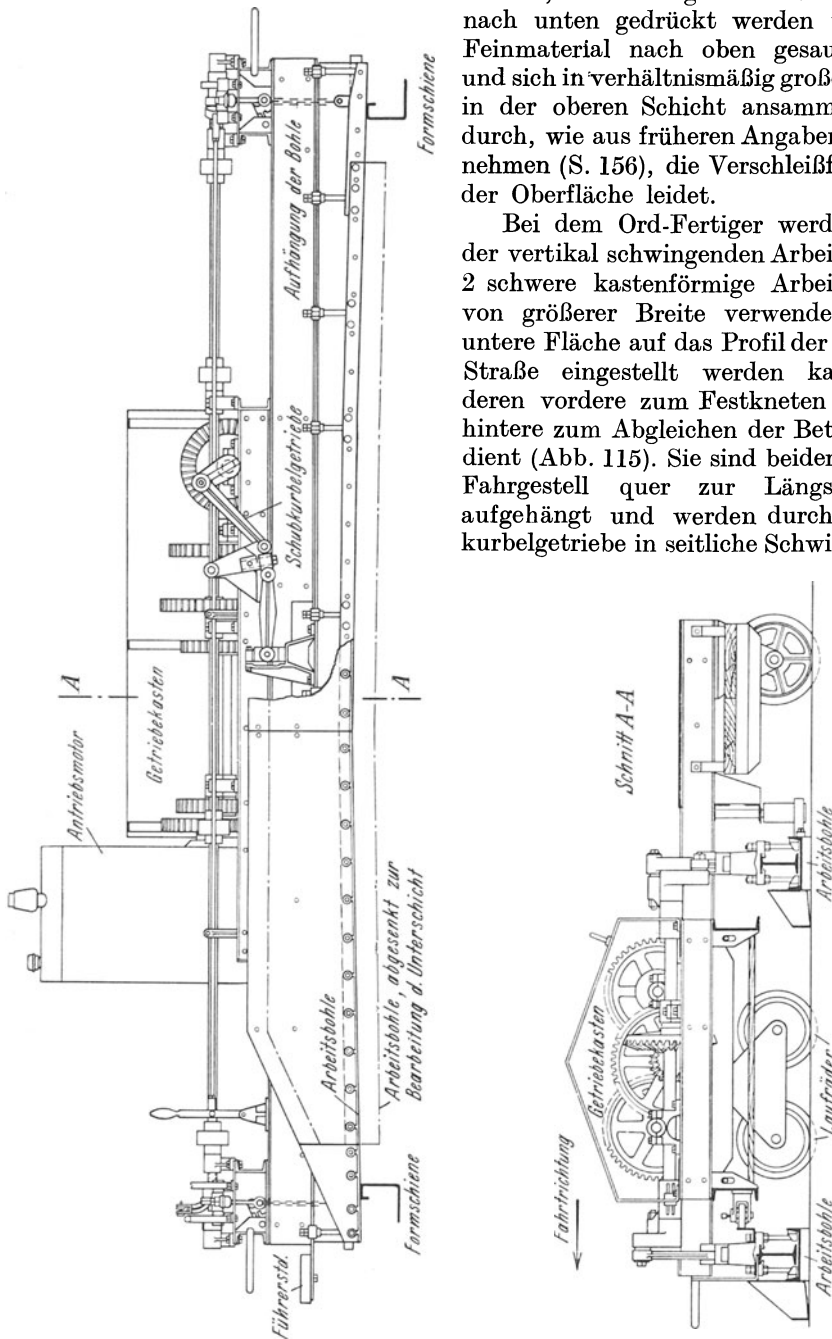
Straßenfertiger mit schwingender Bohle von Kraus & Co.
